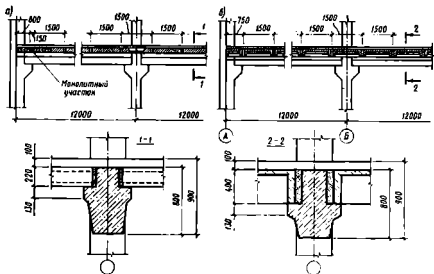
Каркас многоэтажных зданий с пролетами 12+12 м:
